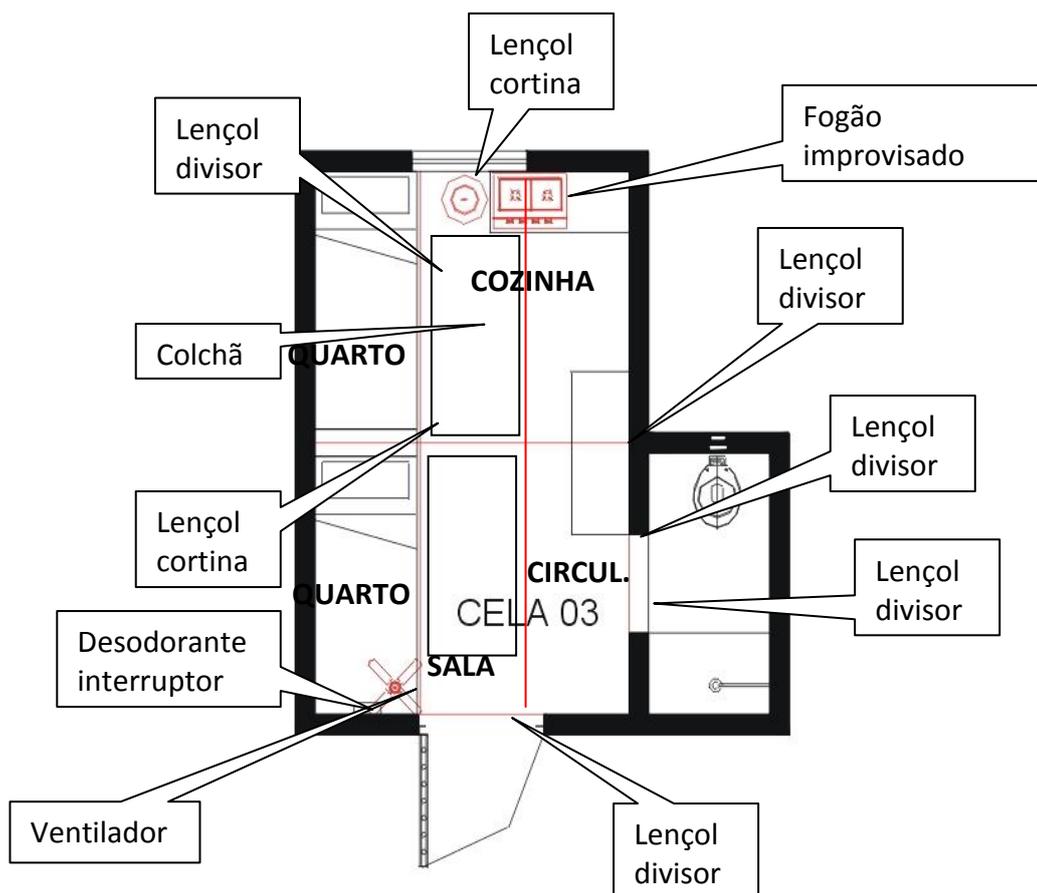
croqui de planta baixa de alojamento modificado, 2006
